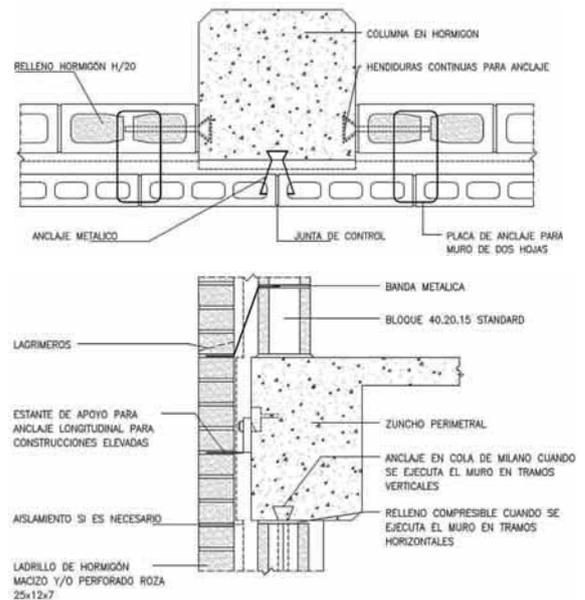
Planta y sección de encuentros de muro de cerramiento de 2 hojas de ladrillo. Hoja exterior de ladrillo de hormigón pasante y apoyada en angular. Hoja interior de bloque de hormigón hueco fijada a soportes.
